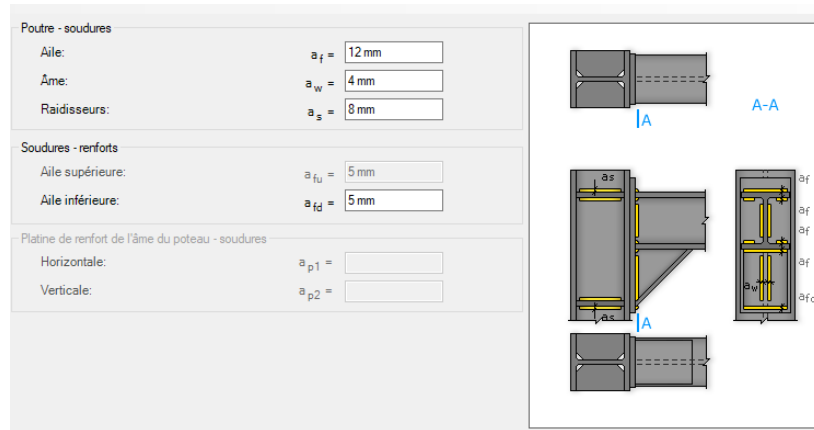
Schéma de la soudure poutre platine
